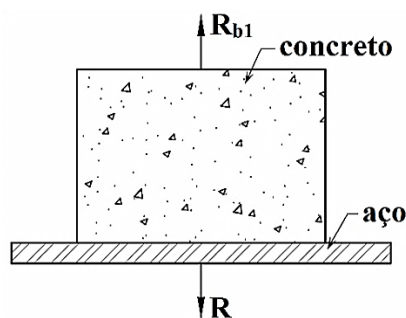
Aderência por adesão - Modificado de Alvarez & Luque (2003).
